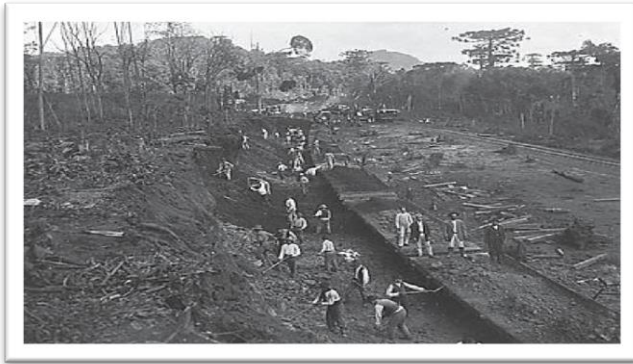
Trabalhadores lançando terra e saibro sobre vagões-prancha para a construção de aterros na implantação da ferrovia.
